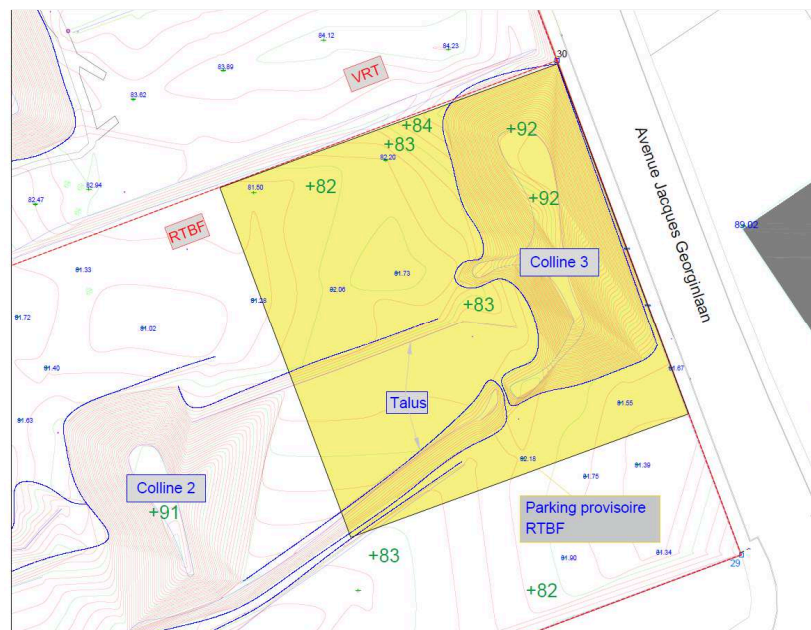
Localisation du parking provisoire sur le plan topographique (Source : Plan niveaux TAW – GEOMODUS cvba 26-09-2016, plan situation projetée parking provisoire)
